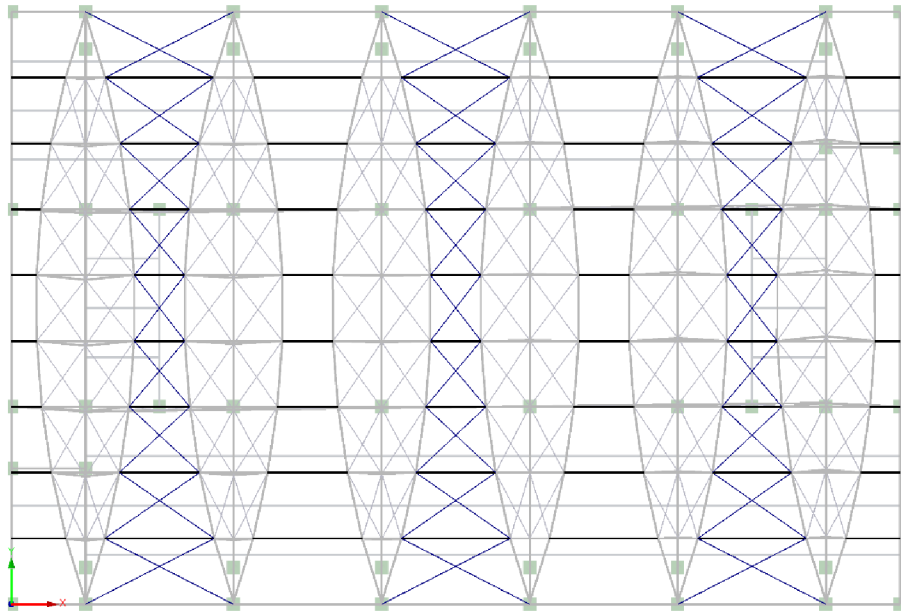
Uspořádání podélného ztužení ve střešní konstrukci.
